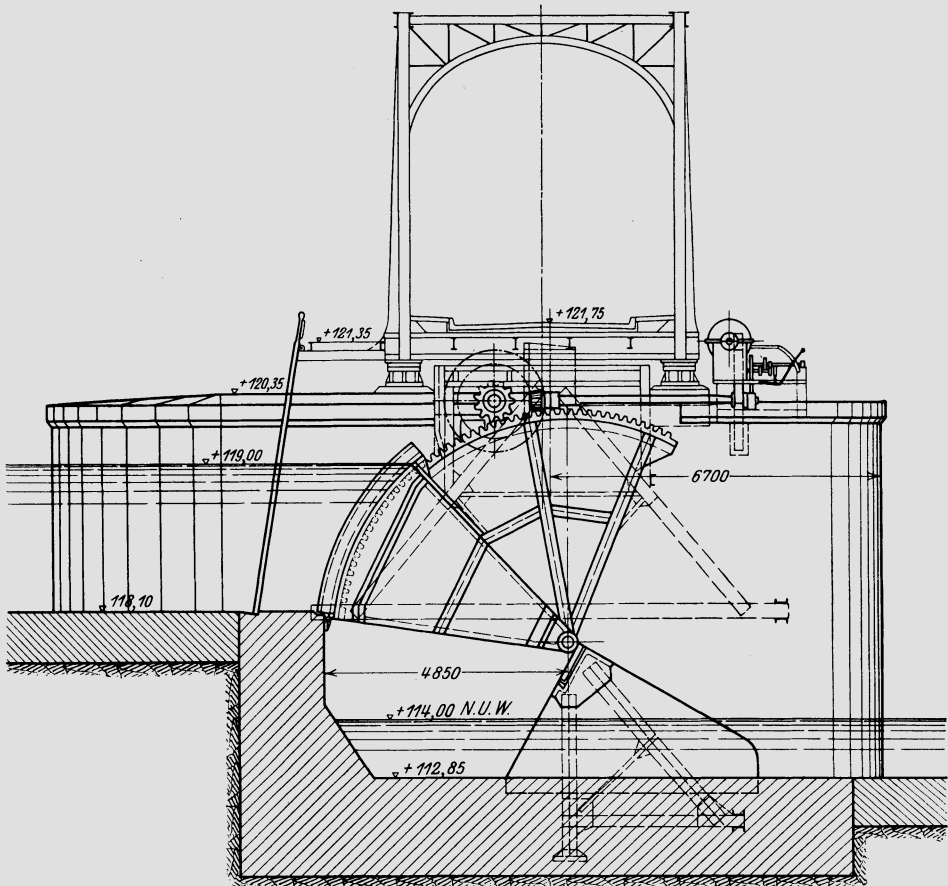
Vesenkbare Segmentwehr nach Louis Eilers. Maßstab 1:155.
